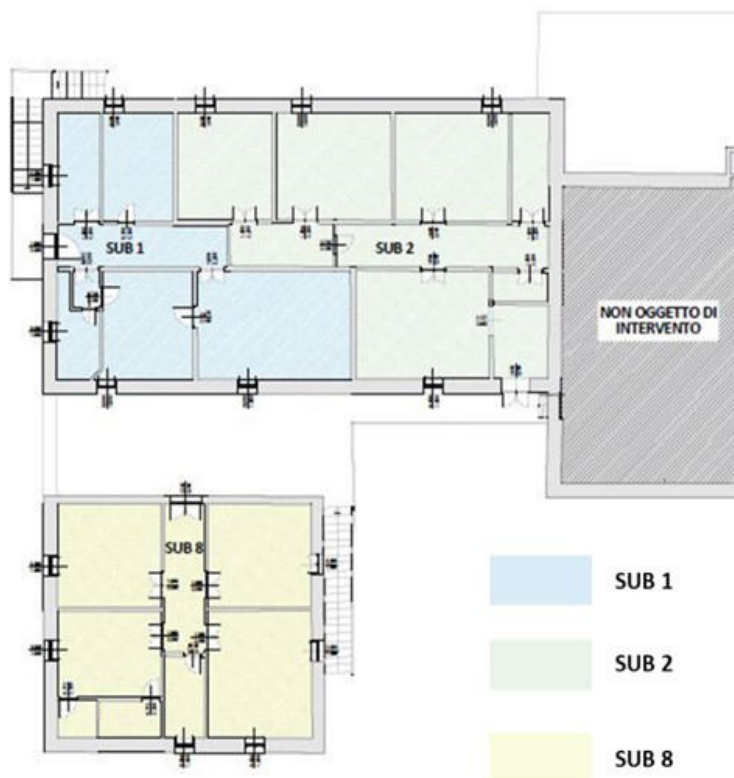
Planimetria stato di fatto Piano Primo – Subalterni oggetto di intervento
